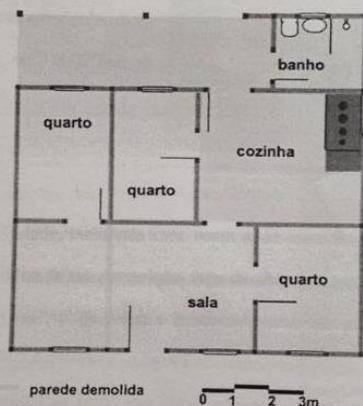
Planta da casa de Dona Efigênia Mendonça.
